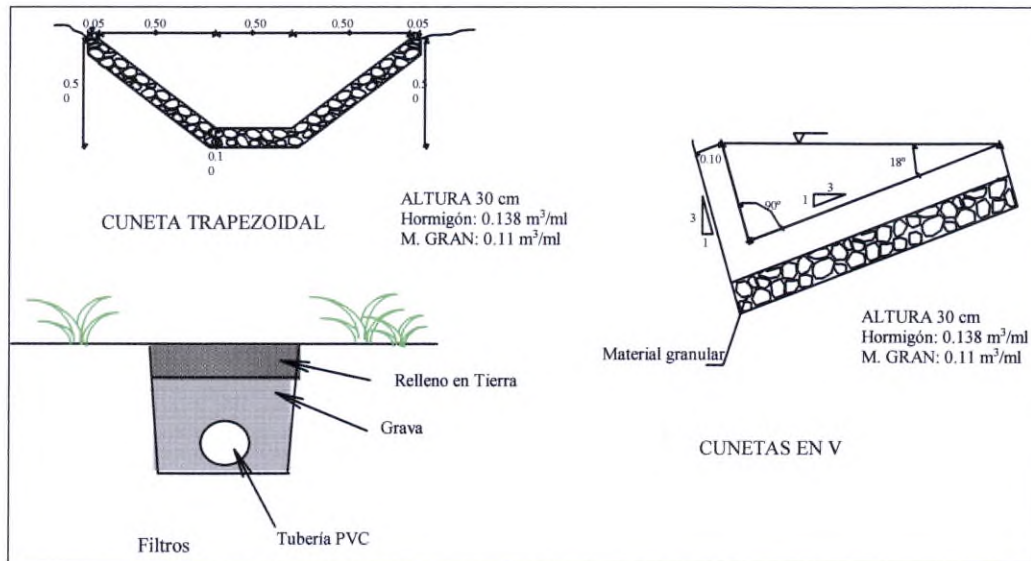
Esquema Típico de Obras de Drenaje - Fuente: Guía Ambiental para redes de Distribución
